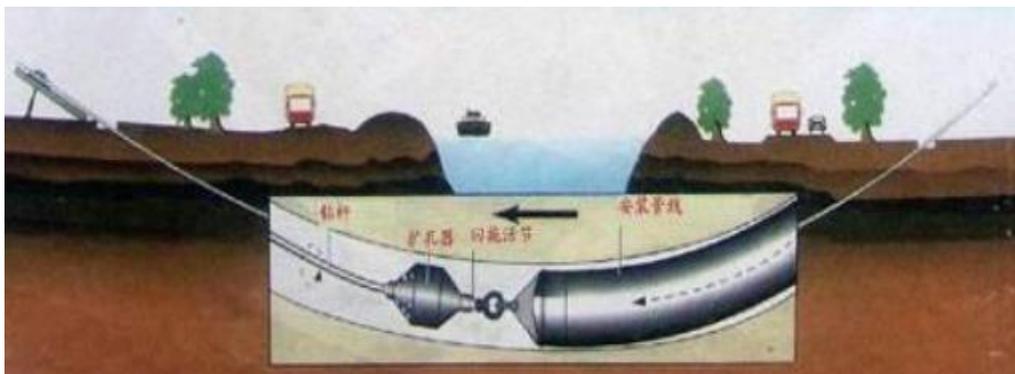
定向钻穿越施工管线回拖过程断面示意图
